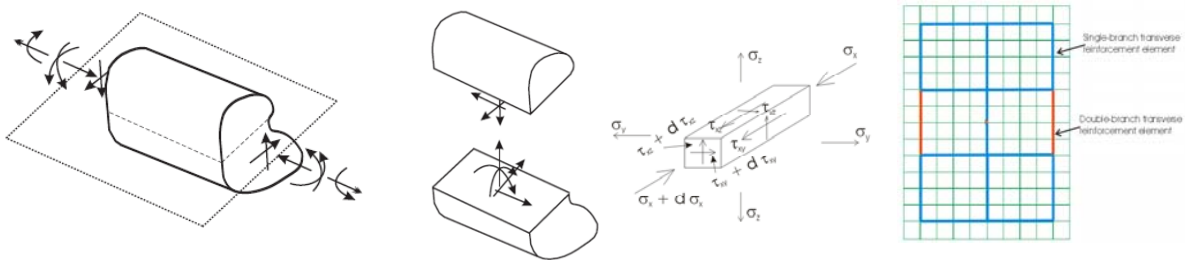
Equilibrio dual a nivel elemento y a nivel sección y representación de armaduras transversales
